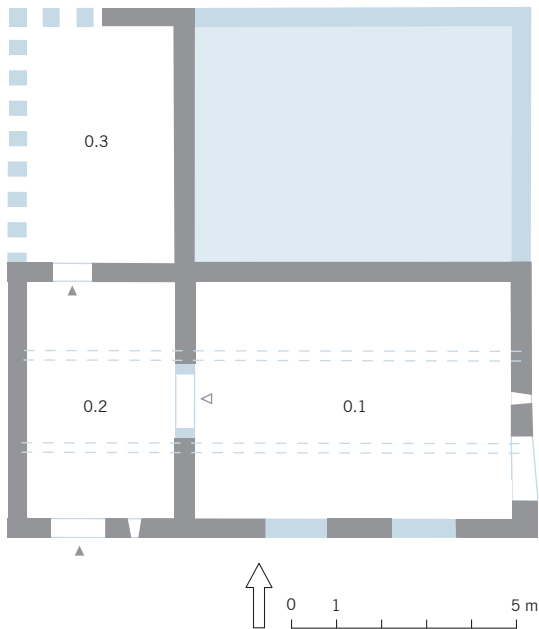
Eggstrasse 57 in Oberägeri, Grundriss des Sockelgeschosses.
